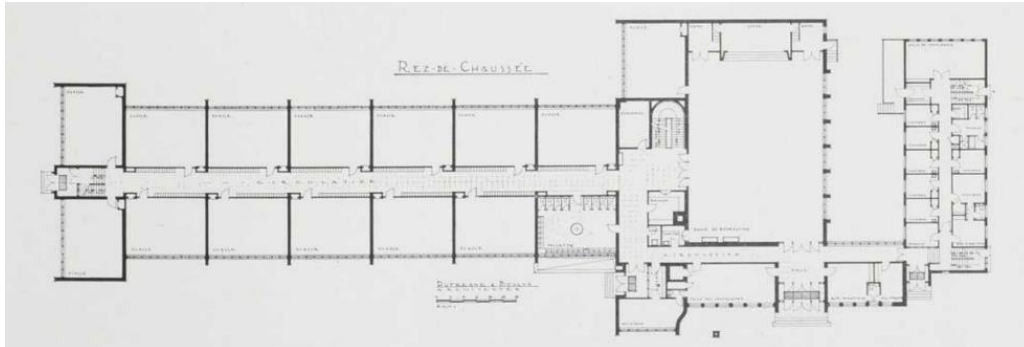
Plan du rez-de-chaussée, 1960. Source : ABC, mai 1960
